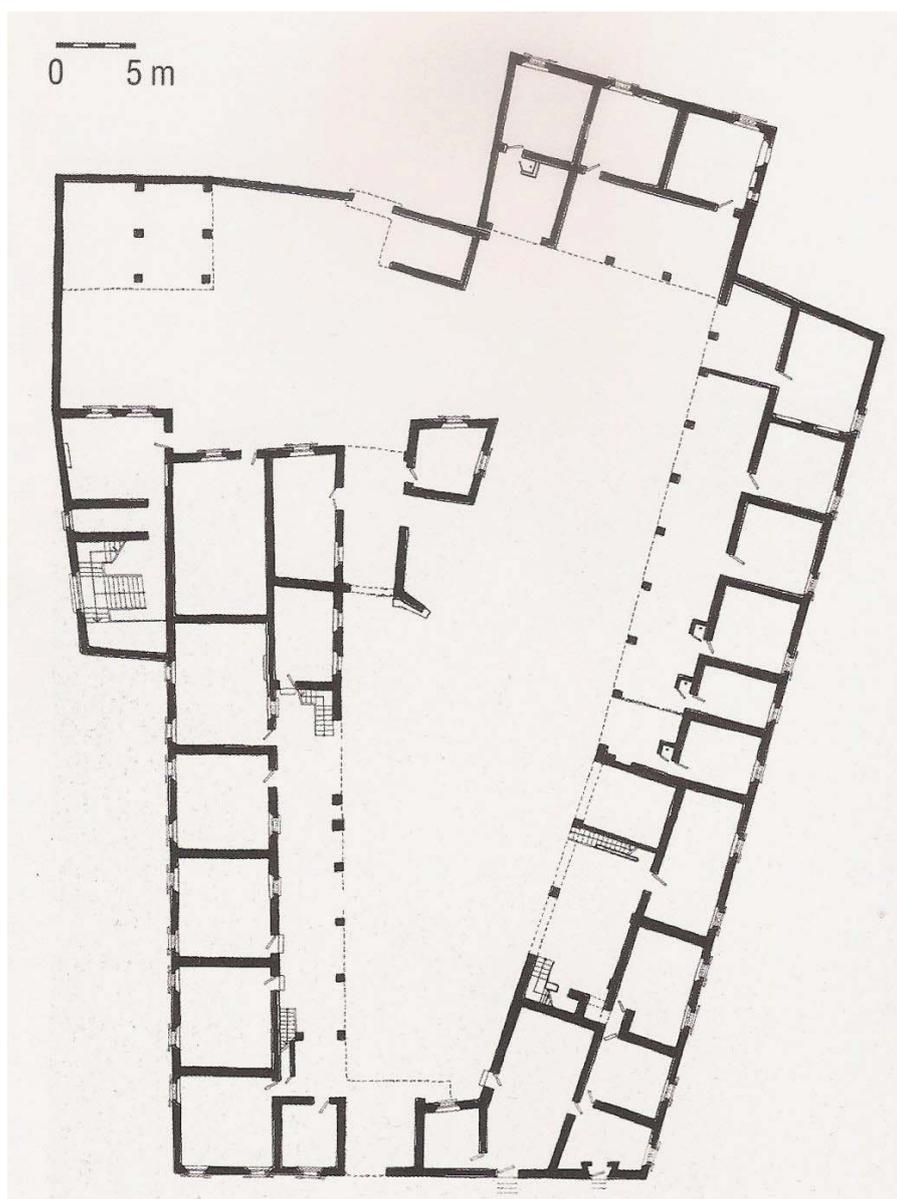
Cantù, Cascina Santa Naga (o Santa Anaga). Pianta piano terra.
